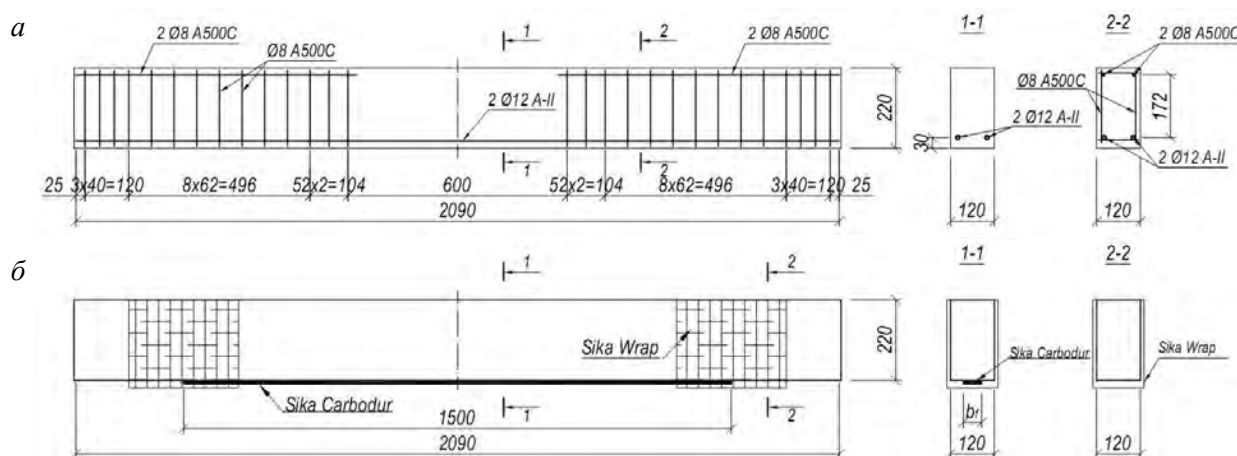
Конструкція та армування експериментальних залізобетонних балок: а – без підсилення; б – з підсиленням (внутрішня арматура умовно не показана)
